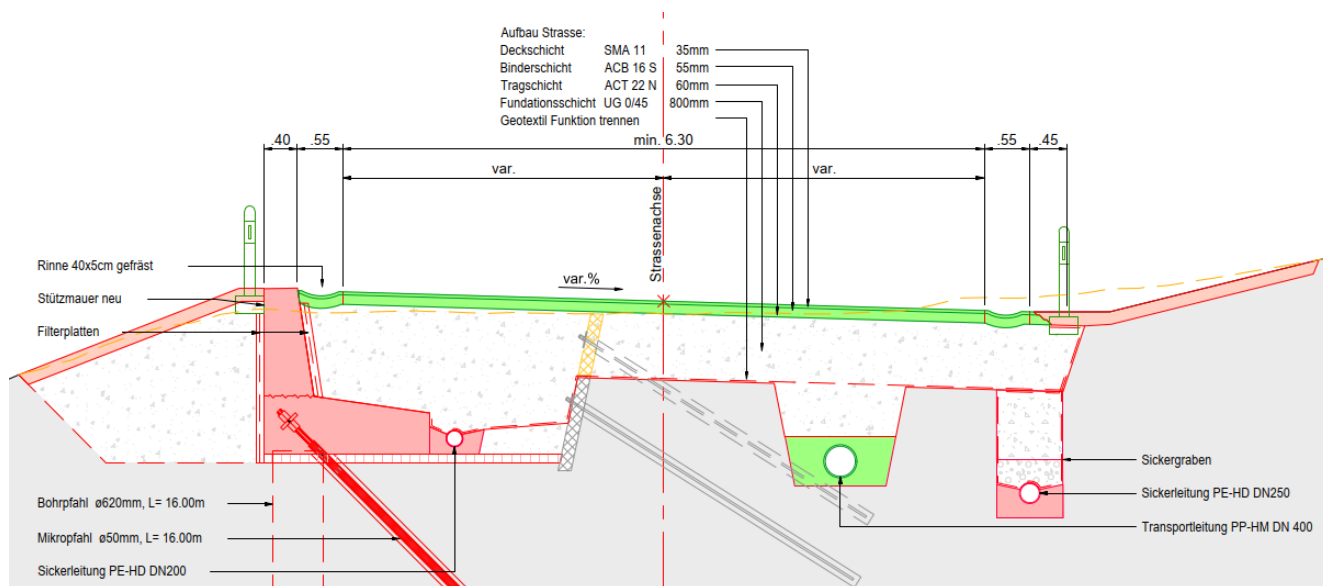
Normalprofil mit Stabilisierungsmassnahmen. Grün: Neubau bereits bewilligt mit Erschliessungsplan 2013 und 2020; Rot: Neubau vorliegende Projektergänzung.
